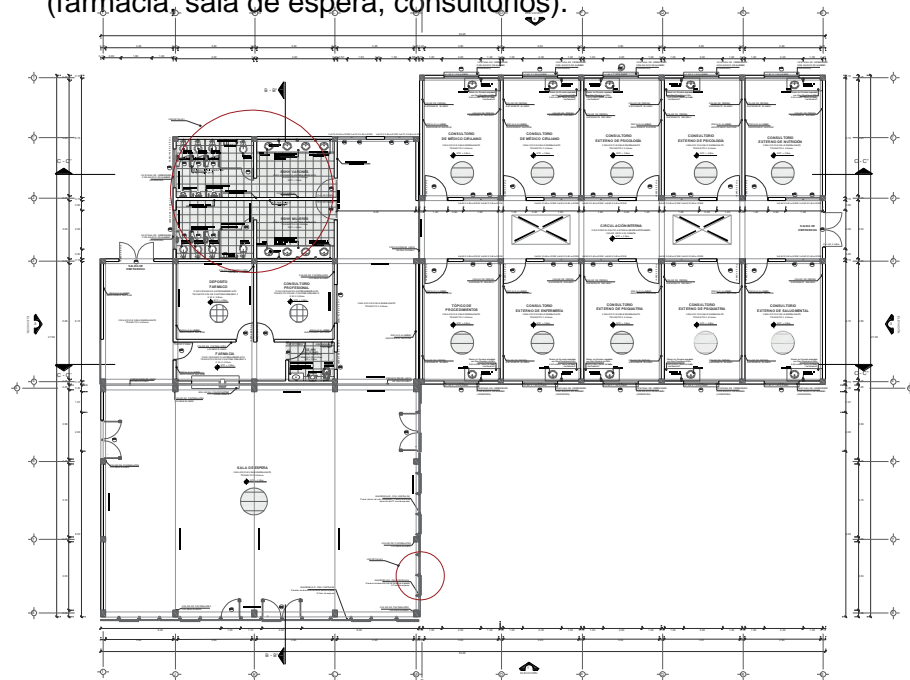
Planta de proyecto - Zona de Consulta Externa - Bloque 03. Elaboración propia.
